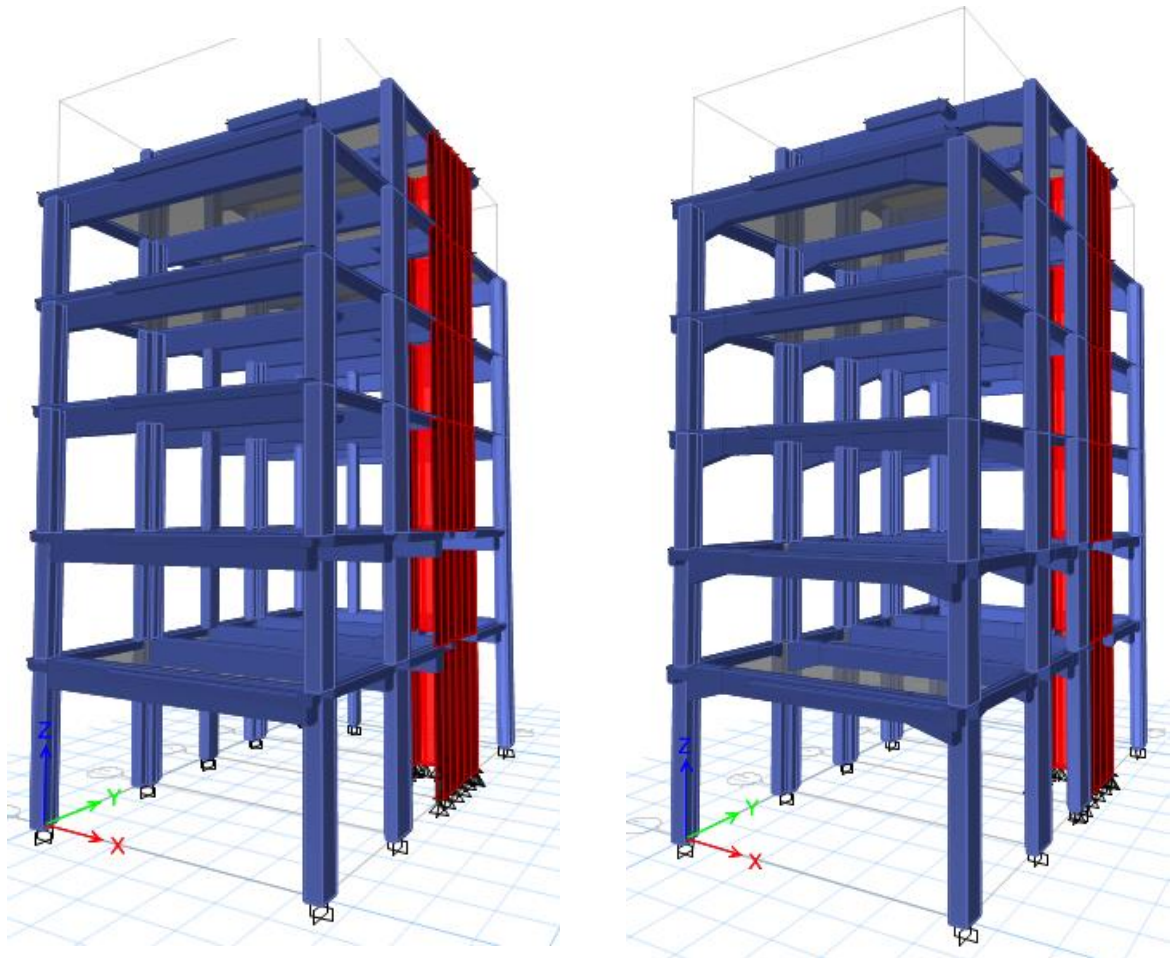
36 Isométrico de las Vigas de Sección Constante y Vigas de Sección Variable.
